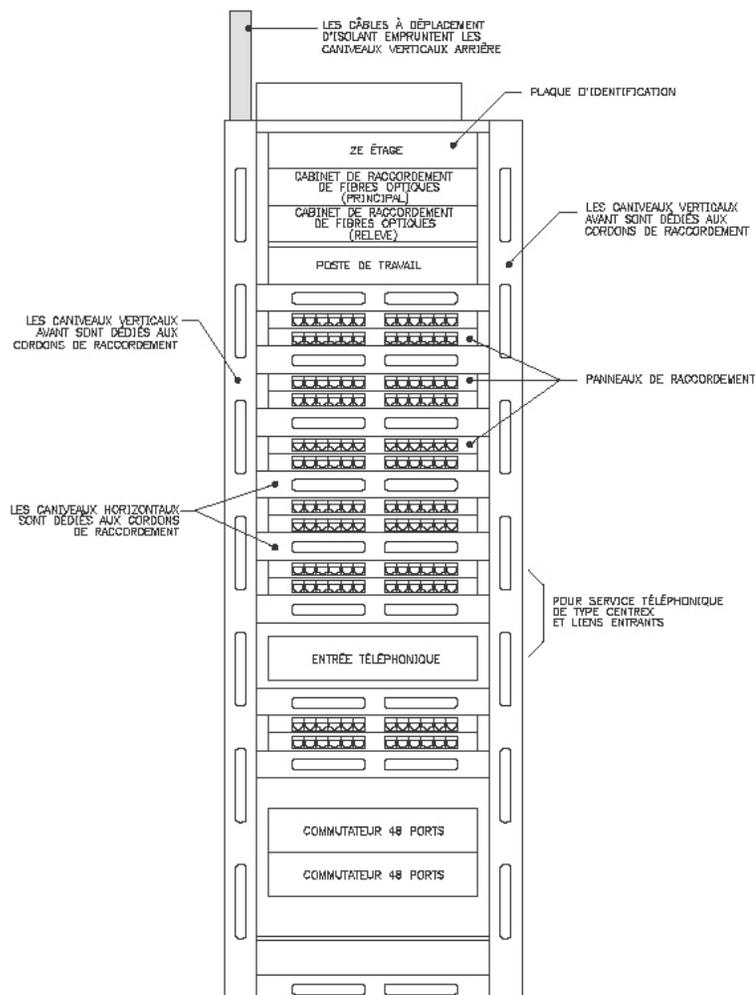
Montage type de panneaux de raccordement sur un râtelier
